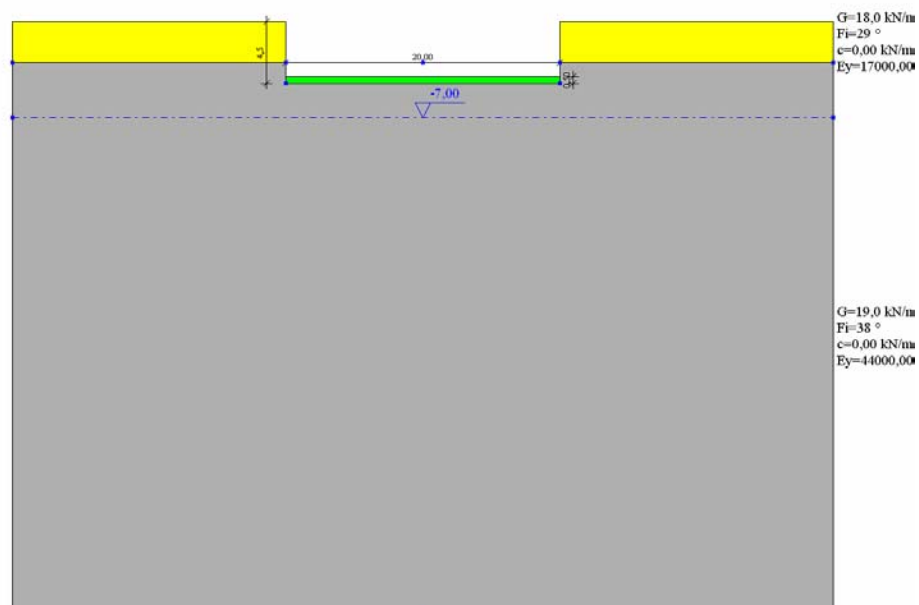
Schema della situazione di calcolo per i cedimenti della platea
